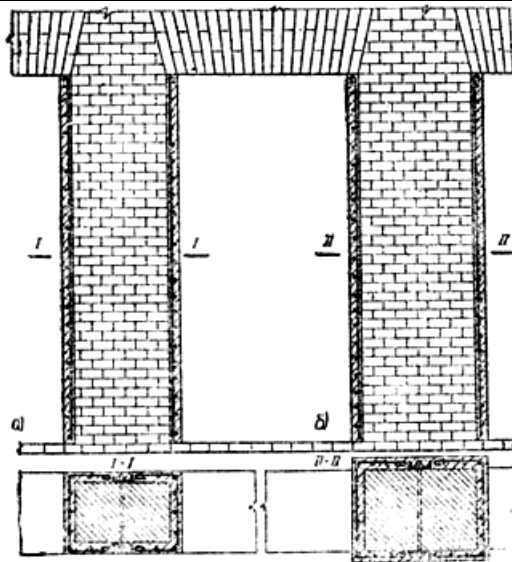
Усиление кирпичного простенка железобетонной обоймой
